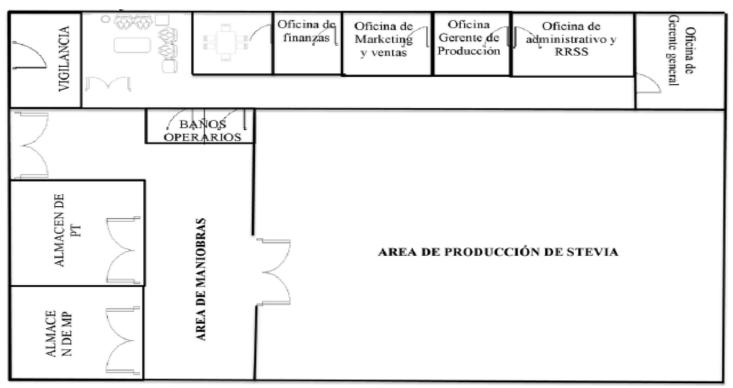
Layout de la Planta de Stevia Sweet Life S.A.C.
